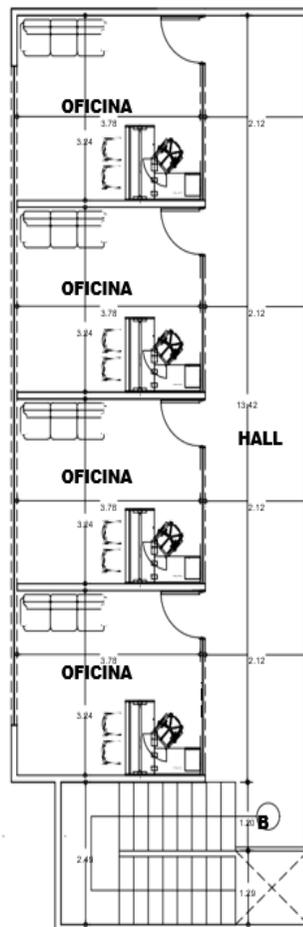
Plano segundo piso planta de harina y aceite de pescado PEZHYA.
